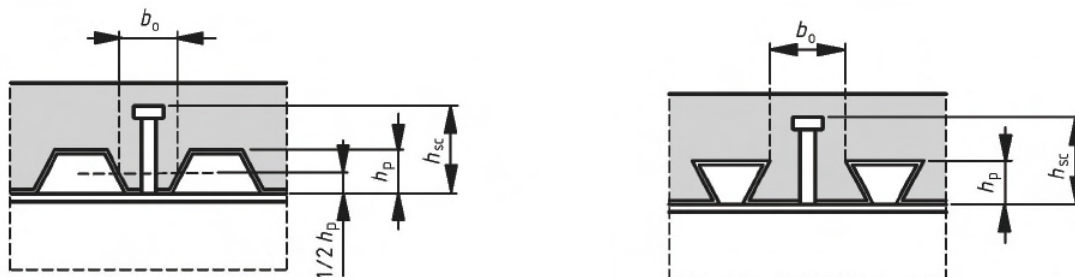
Viga con chapa de acero perfilado transversal a la viga
